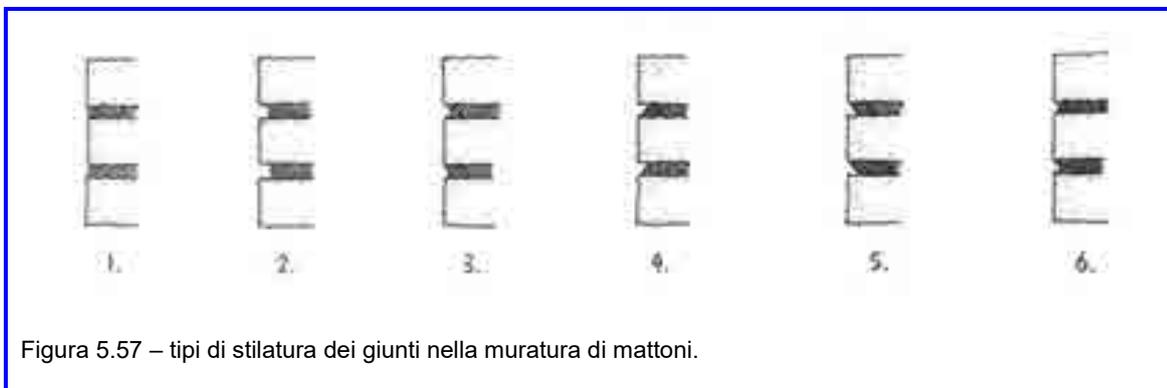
tipi di stilatura dei giunti nella muratura di mattoni.
